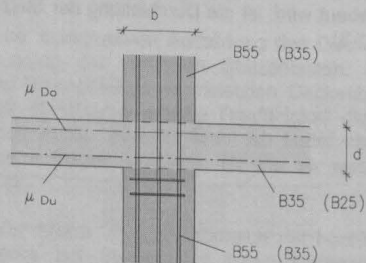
Stahlbetondecke über hochfester Stahlbetonstütze durchgehend
